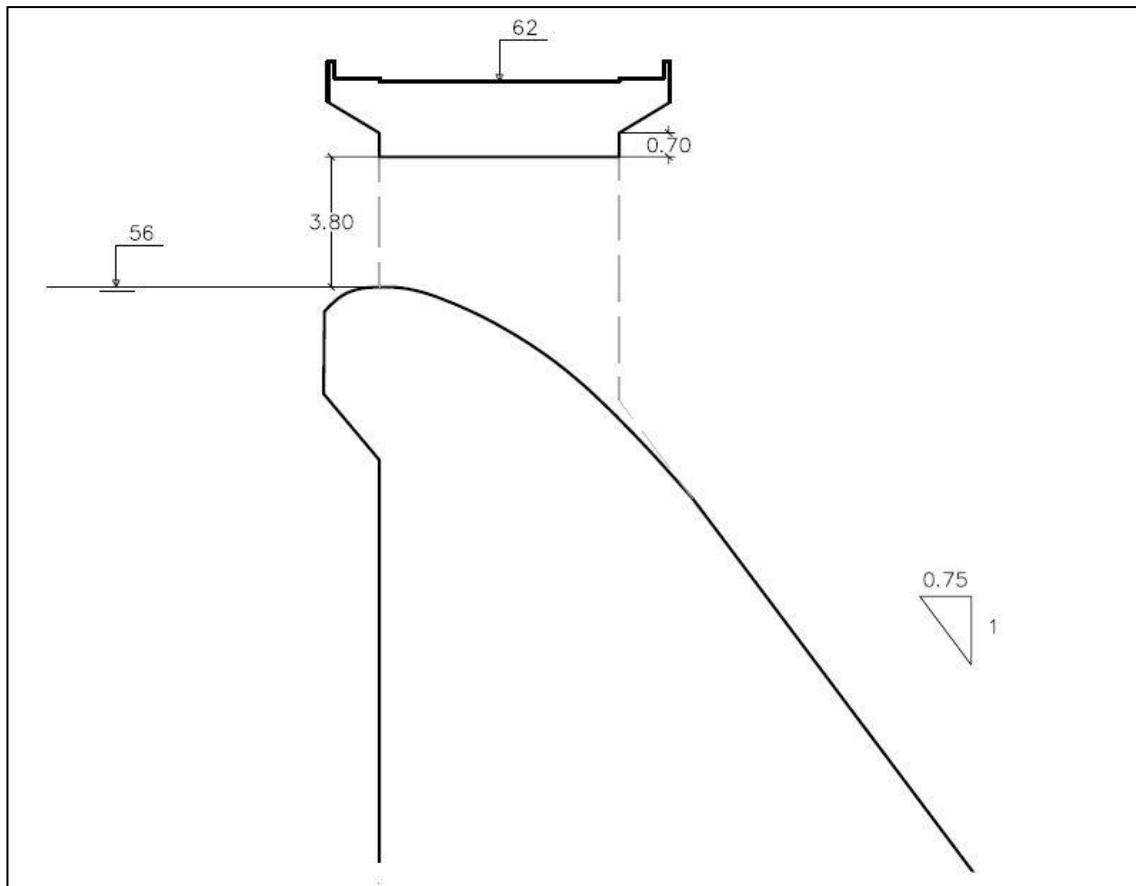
Sección de presa por la zona del aliviadero con cotas en metros.
